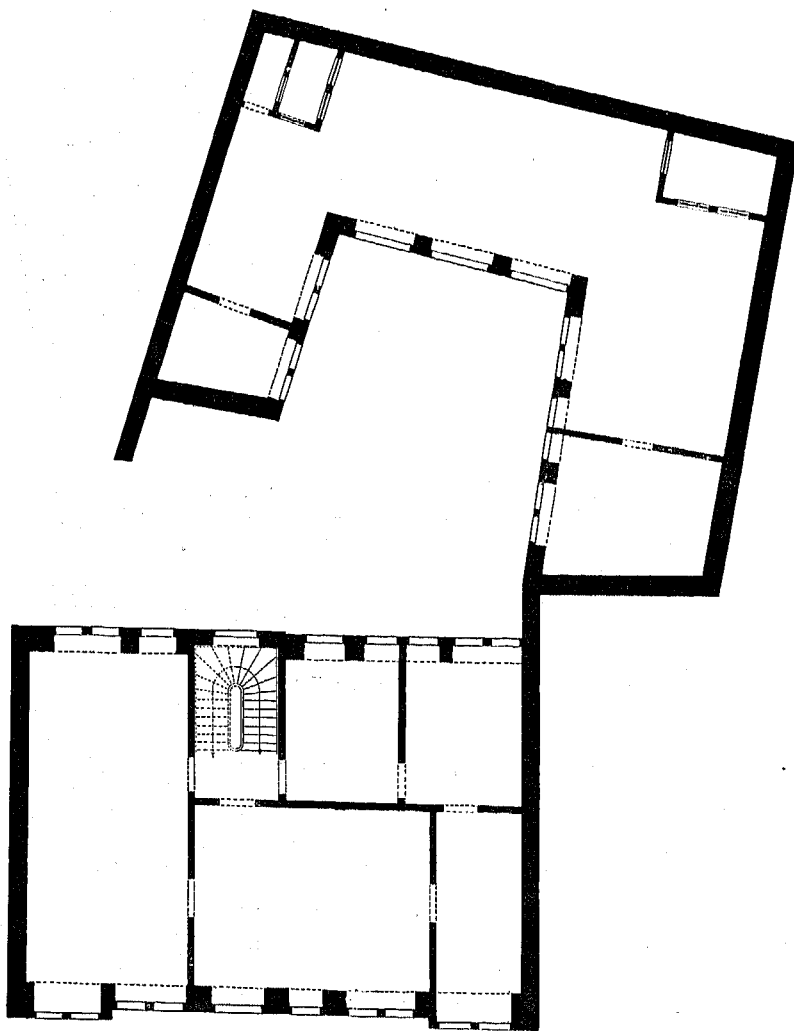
Engelthaler Hof; Grundriss des ersten Obergeschosses.
